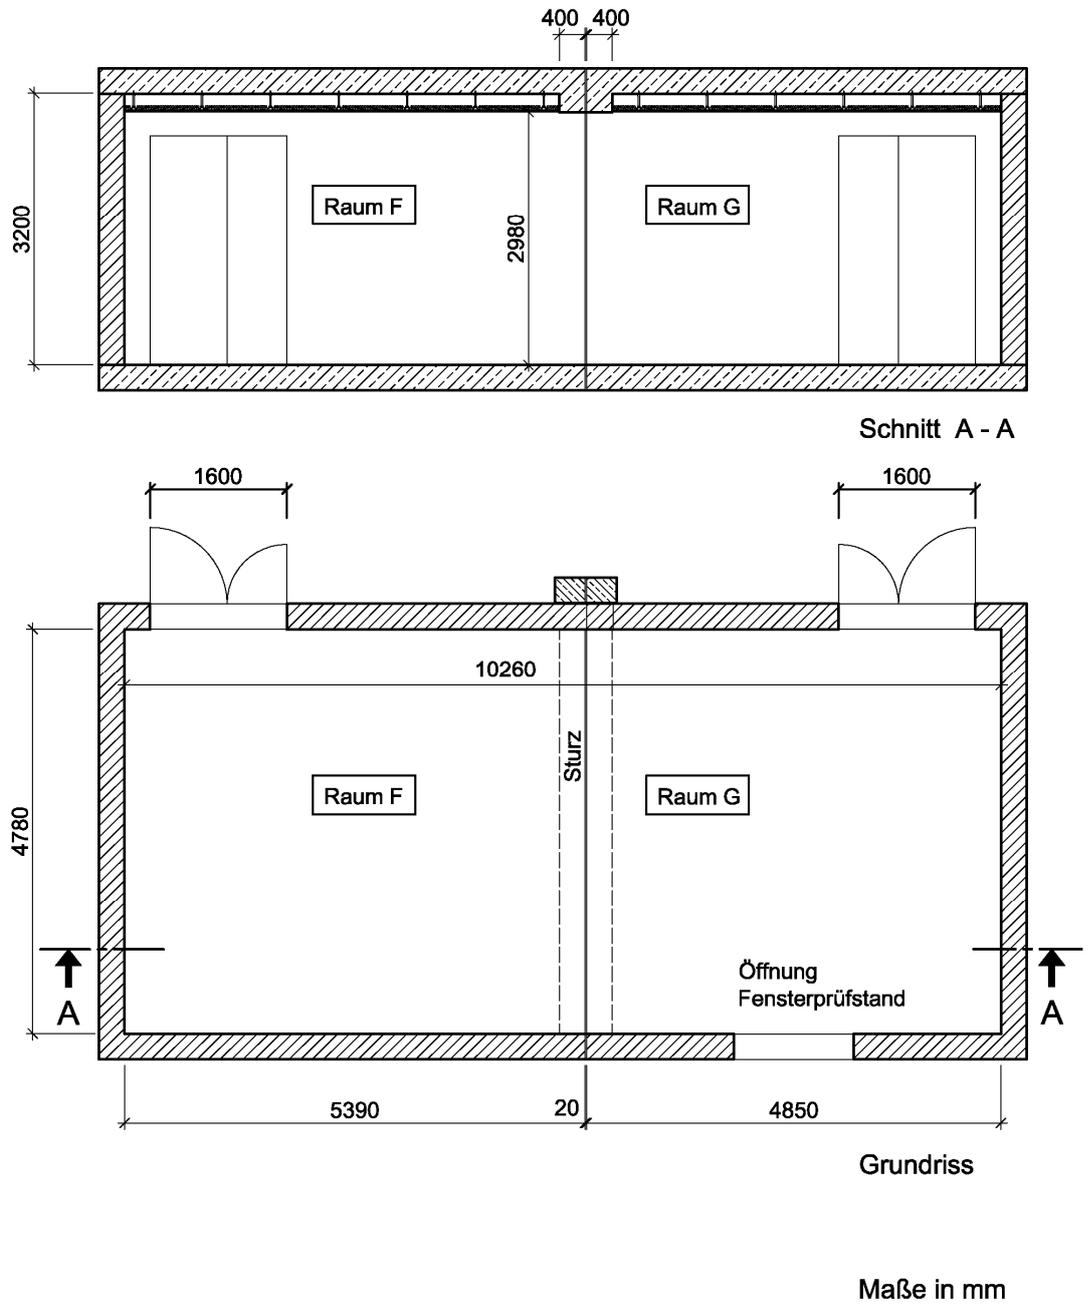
Grundriss und Schnitt des Wandprüfstands.
